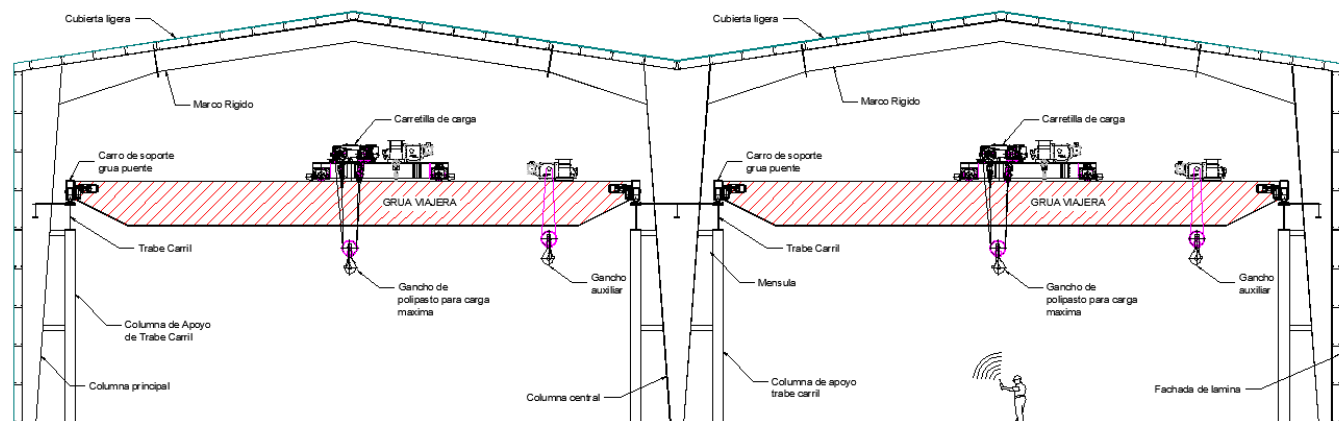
Estructura principal en dos crujeas a base de columnas de acero de sección variable con adosado de columna para apoyo de trabe carril y trabe de acero de sección variable a dos aguas para la cubierta.
